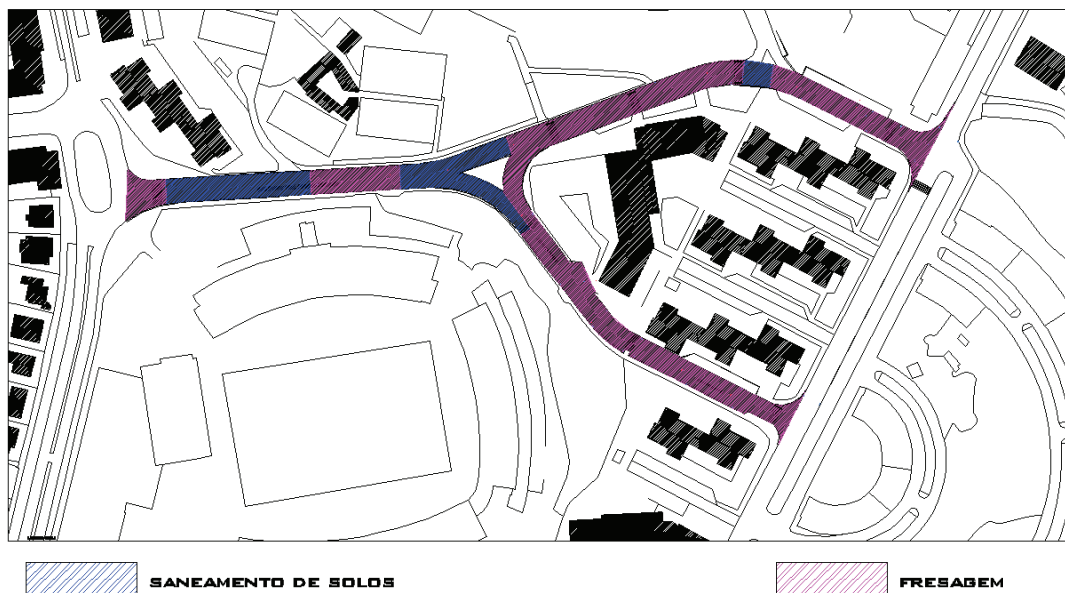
Planta de trabalhos de pavimentação na Rua Prof. Dr. Arnaldo Sampaio e Rua Dr. José Pinto Rodrigues.
